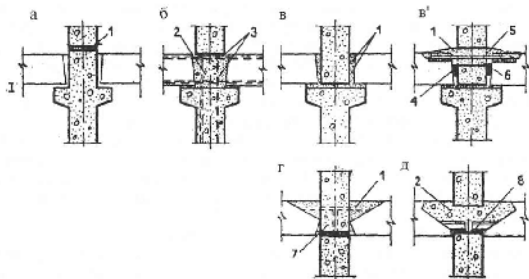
Контактные стыки панелей внутренних стен с опиранием перекрытий на консоли стен: а – горизонтальный стык на растворе расположен выше уровня перекрытий; б – стык через монолитное ядро; в – стык на растворе в уровне низа перекрытий; в' – то же, а в зоне связей между перекрытиями через отверстия в панели стены; г, д – контактные стыки на пальцах (бетонных или стальных); 1 – цементный раствор; 2 – монолитный бетон; 3 – арматурные выпуски; 4 – звукоизоляционные прокладки; 5 – стальная накладка; 6 – отверстие в стеновой панели; 7 – железобетонный "палец"; 8 – стальной "палец"
